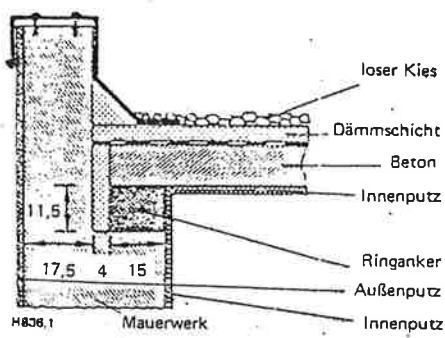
Baukonstruktive Ausführung der dreidimensionalen Ecke (Attikabereich)
